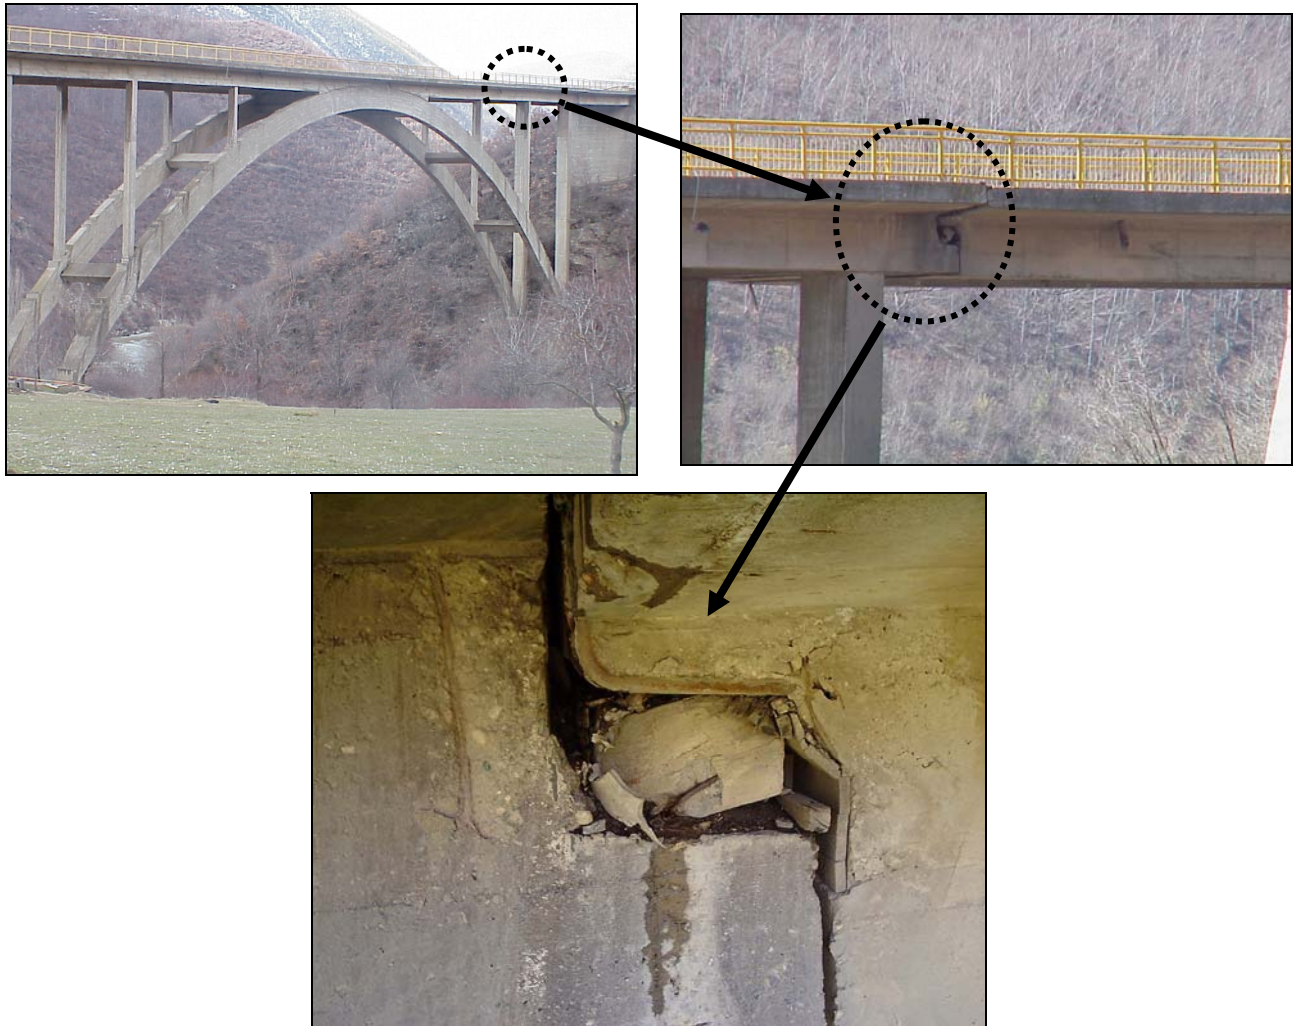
Deterioro y sobre-giro de los apoyos en la conexión tipo voladizo.
